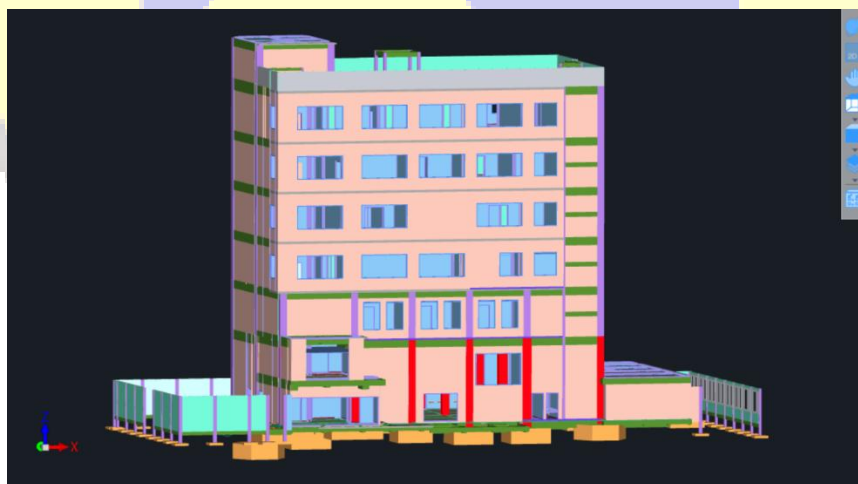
10 3D Model Gedung Powerhouse Autodesk Revit
